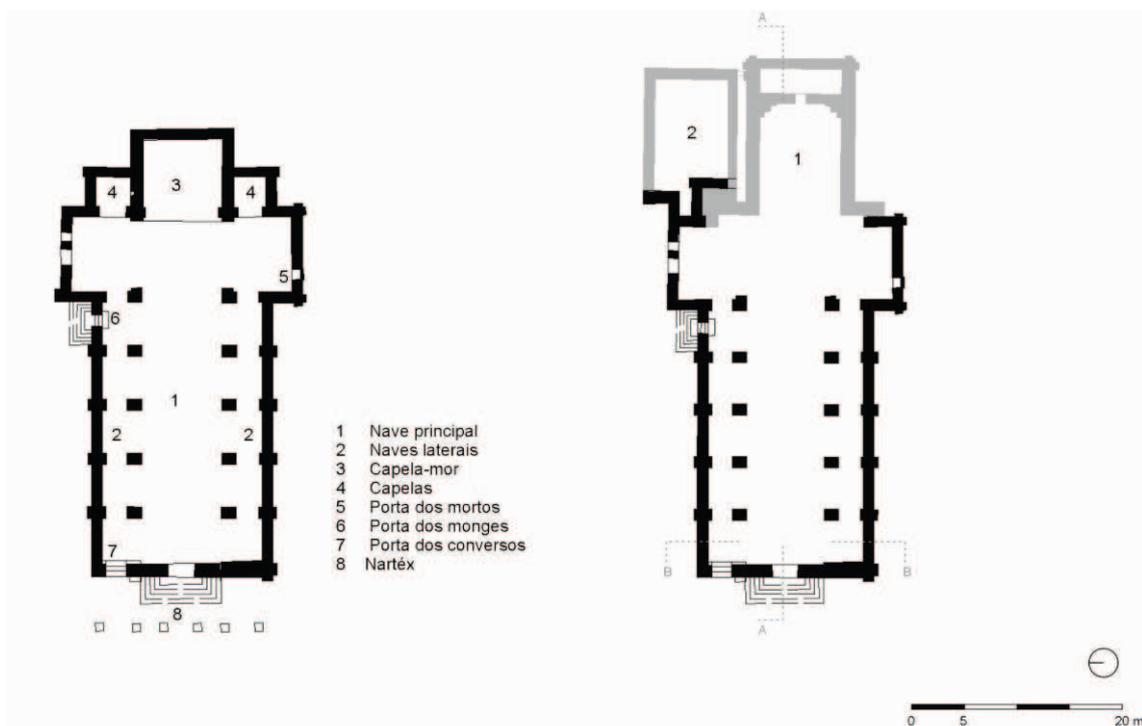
Igreja do mosteiro de S. João de Tarouca, a primeira planta representa a reconstrução da planta original do mosteiro, a segunda representa a planta actual. (adaptado da ilustração de Luís Sebastian e Ana Castro).²⁷⁴
